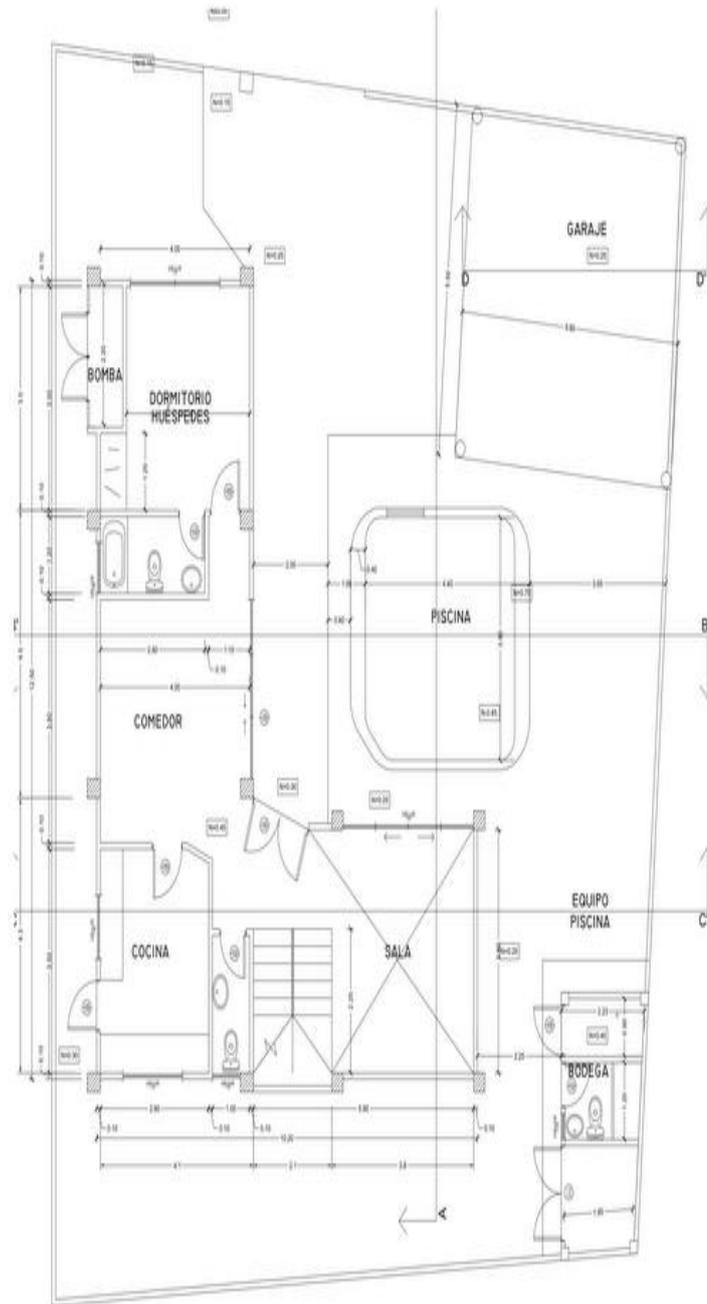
Planos de Proyecto. 2017. Fuente: Tutor de Trabajo de Grado
